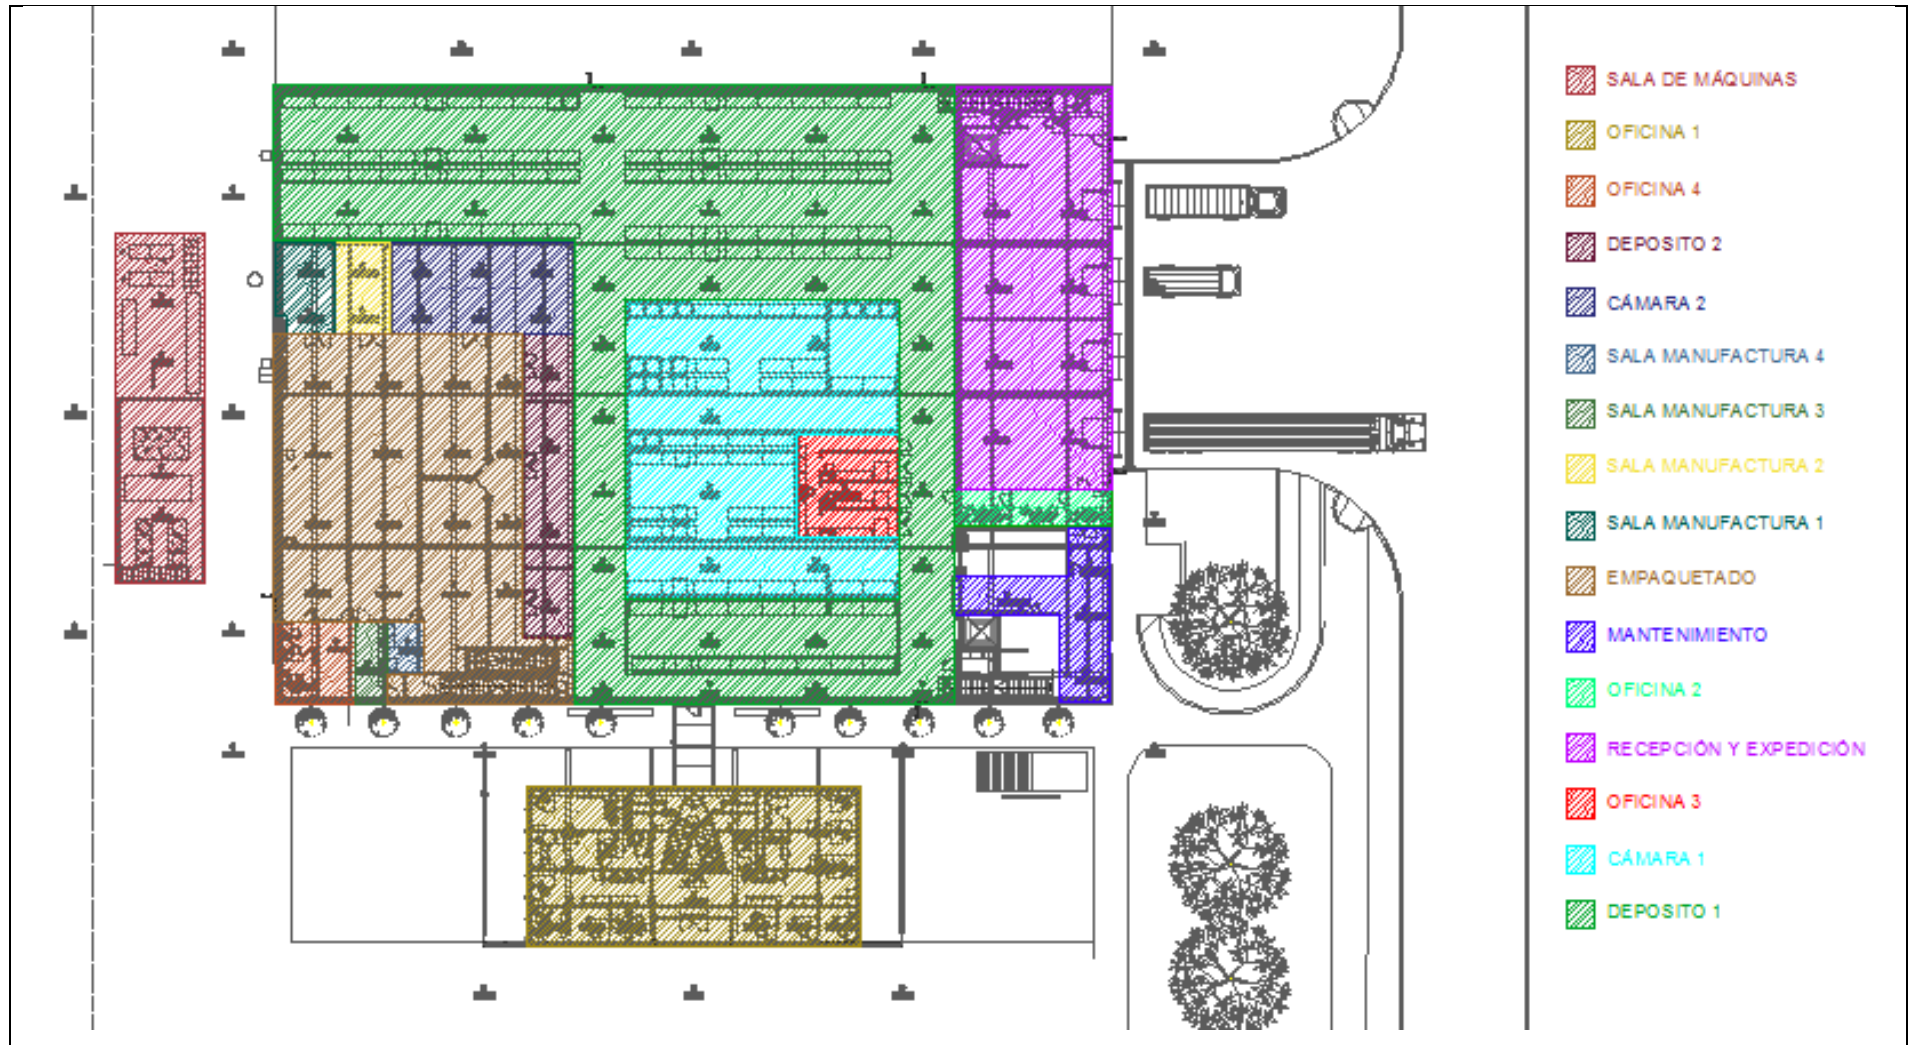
Plano de planta del laboratorio con divisiones por sector correspondiente a Planta Baja
